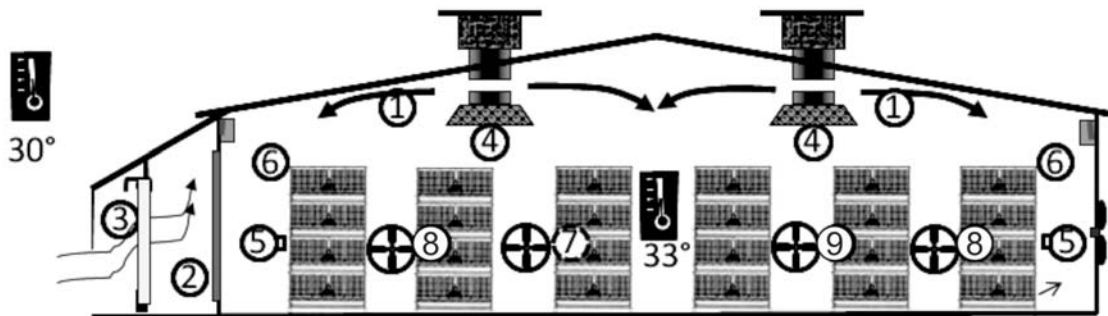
Minimum Ventilation mit Dachzuluft (Fumus)
